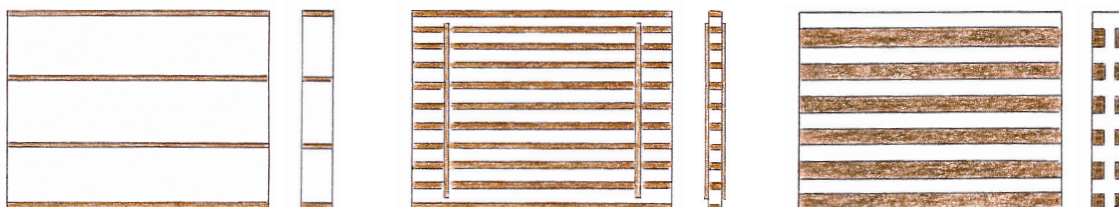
Elévations et sections : a) Maçonnerie avec insertions horizontales en bois occupant toute la section murale ; b) Maçonnerie de faible épaisseur avec insertions horizontales en bois rapprochées ; c) Maçonnerie épaisse avec insertions horizontales en bois rapprochées.
